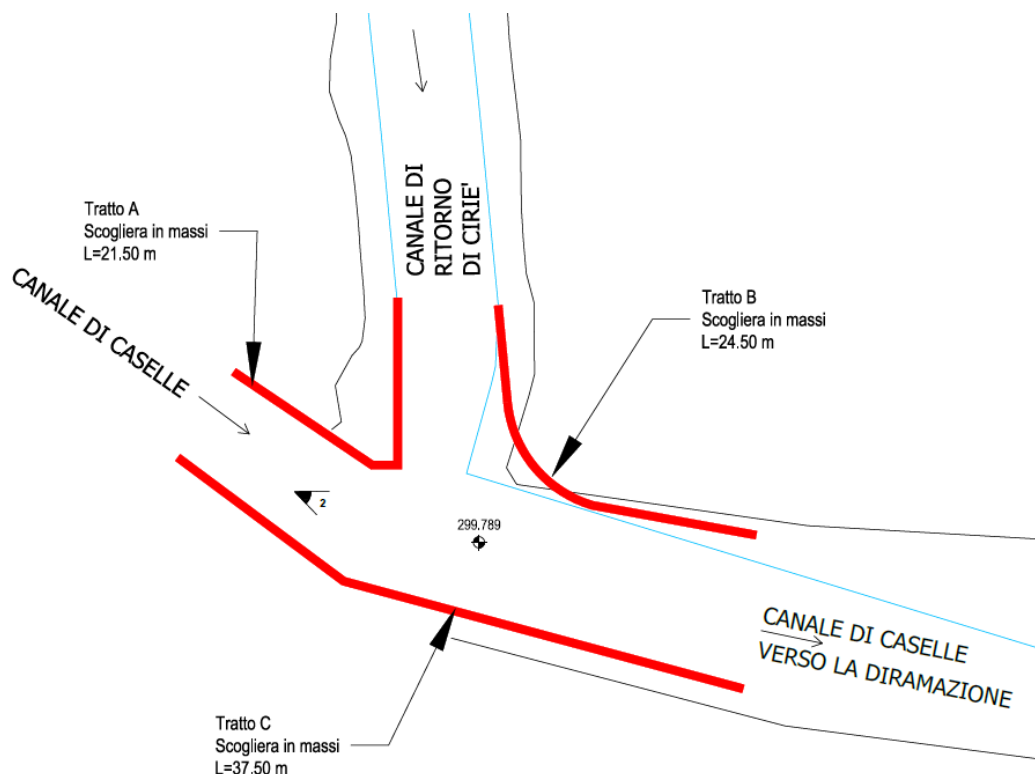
Planimetria di dettaglio del nodo idraulico formato dall'intersezione della Bealera Sturetta ed il canale scolmatore di Cirié.
